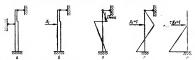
Расчетная схема многопролетного поперечника с ригелями в разных уровнях.
